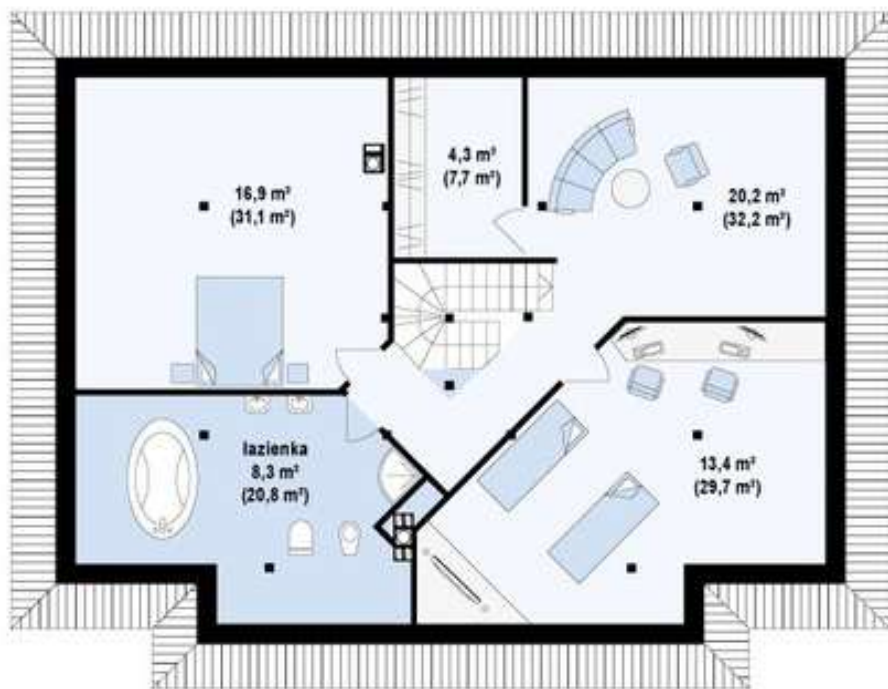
План об'єкта охорони (план другого поверху)
